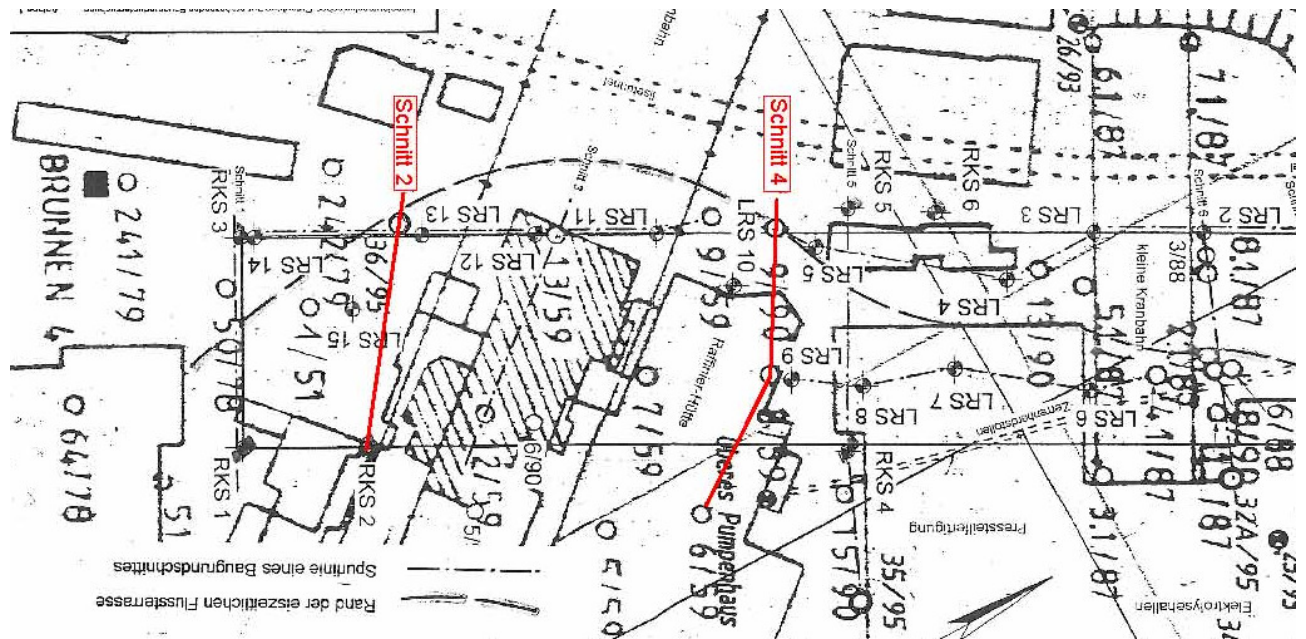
Lageplan mit Schnittführung /1/, bearbeitet
